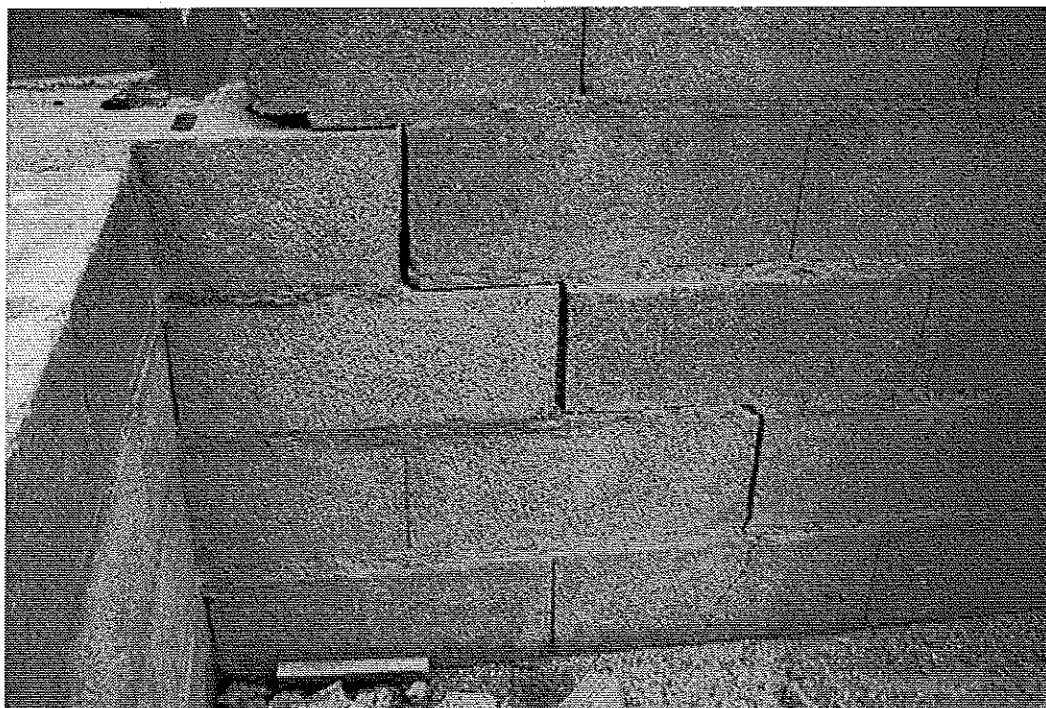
Détail fissure en escalier dans un refend transversal d'étage (zone de débord en console). © J. Putatti
